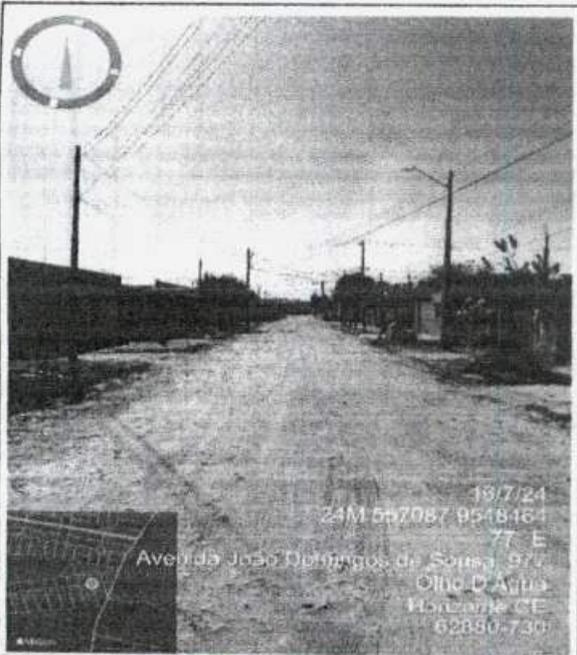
FOTO Nº	AVENIDA JOÃO DOMINGOS DE SOUSA
